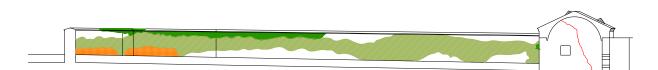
Relevamiento de lesiones - Fachada interna Este - Segundo Patio
